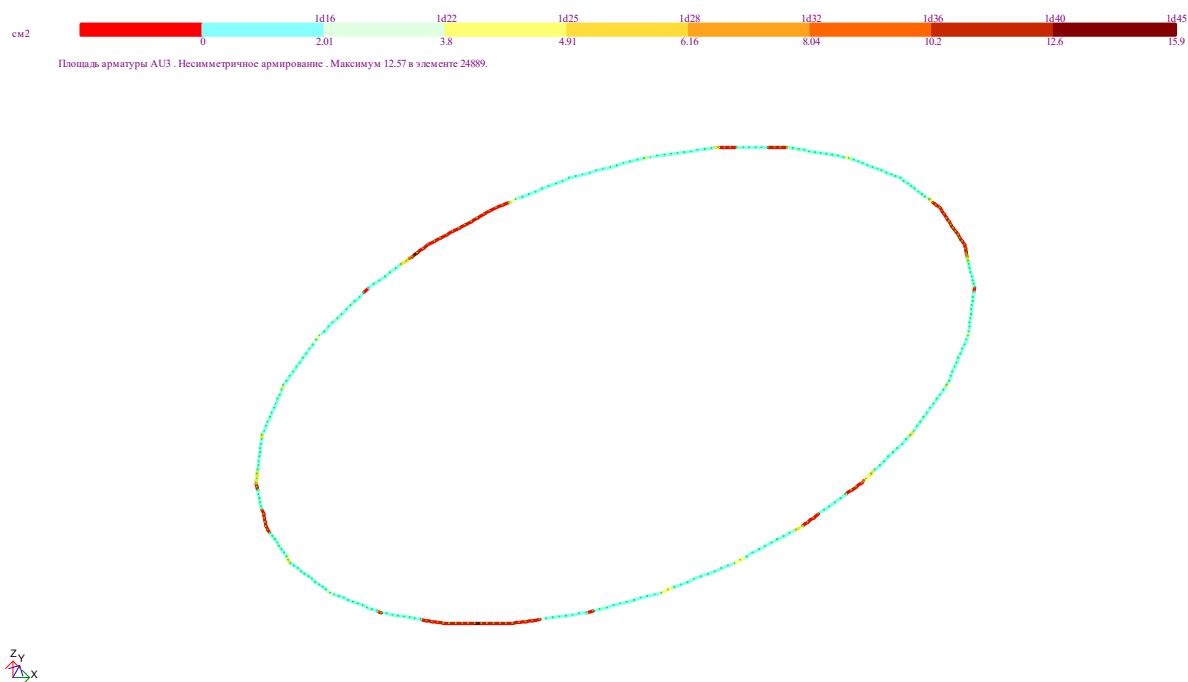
Верхнє армування по кутах залізобетонного ригелю
